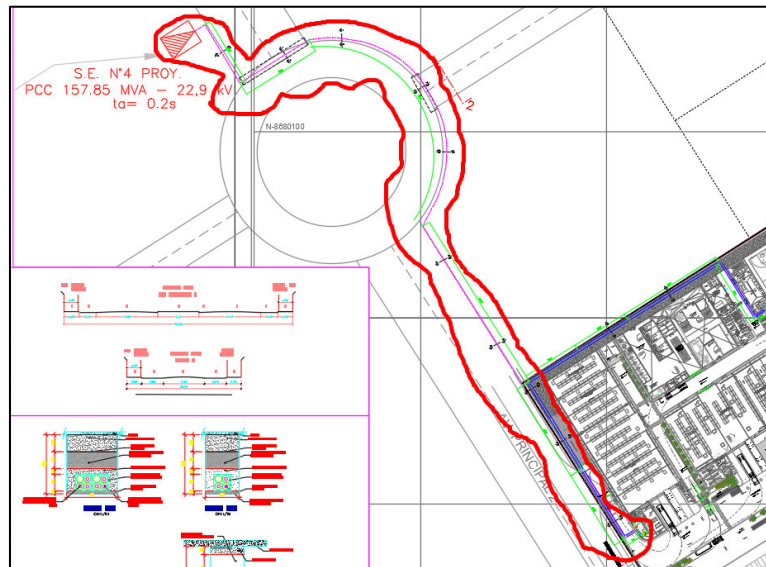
Recorrido de redes subterráneas externas desde la subestación de LDS a la N°1. Fuente: Daca Ingeniería y Proyectos S.A.C.
